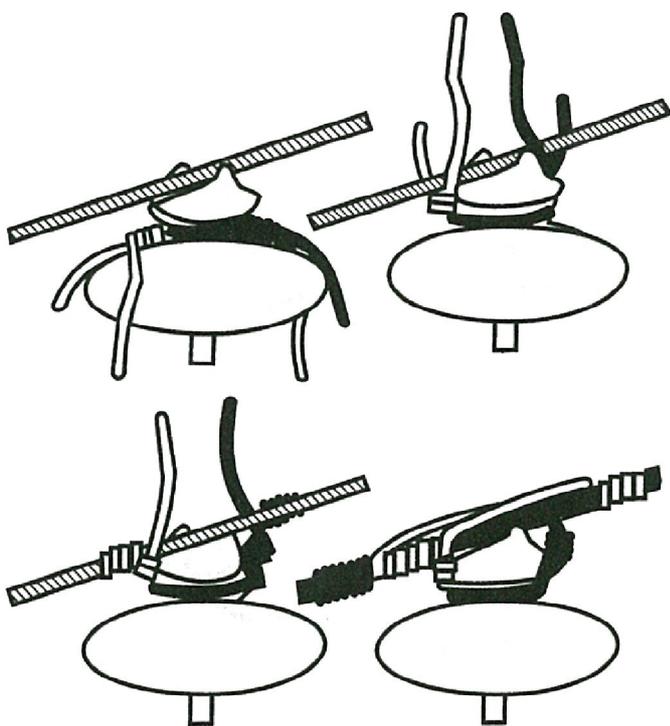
Схема вязки проводов к головке штыревого изолятора
